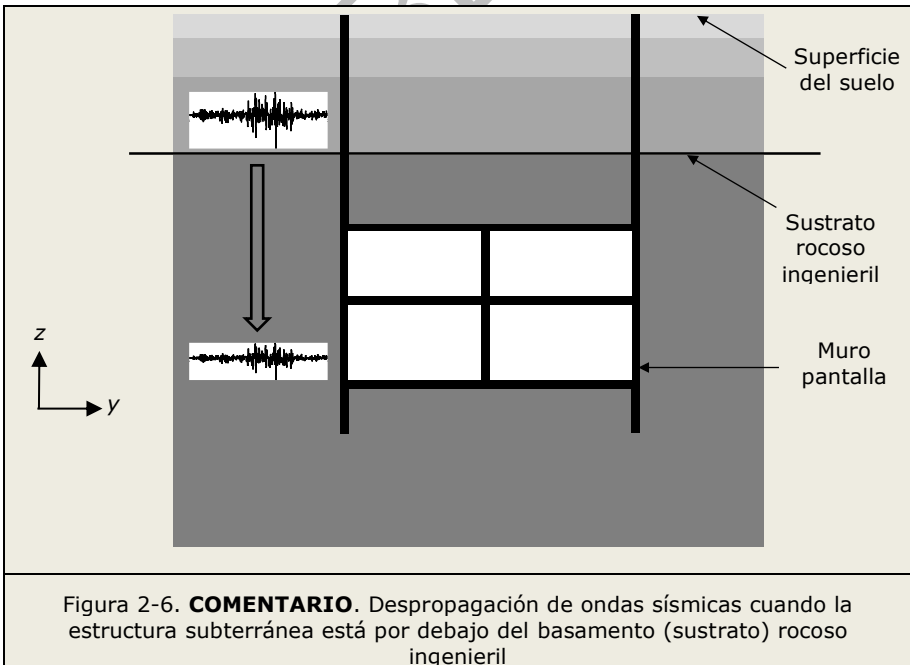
COMENTARIO. Despropagación de ondas sísmicas cuando la estructura subterránea está por debajo del basamento (sustrato) rocoso ingenieril
